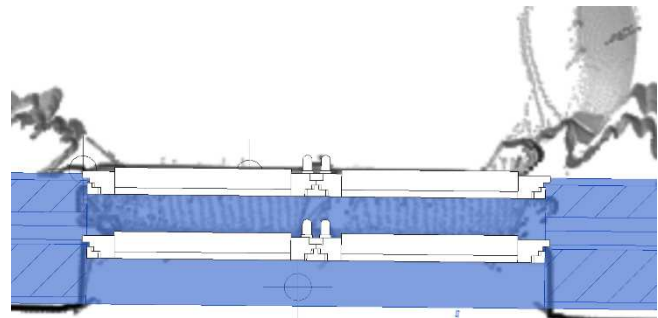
Detalle de la colocación en planta con apoyo de las ortofotos
